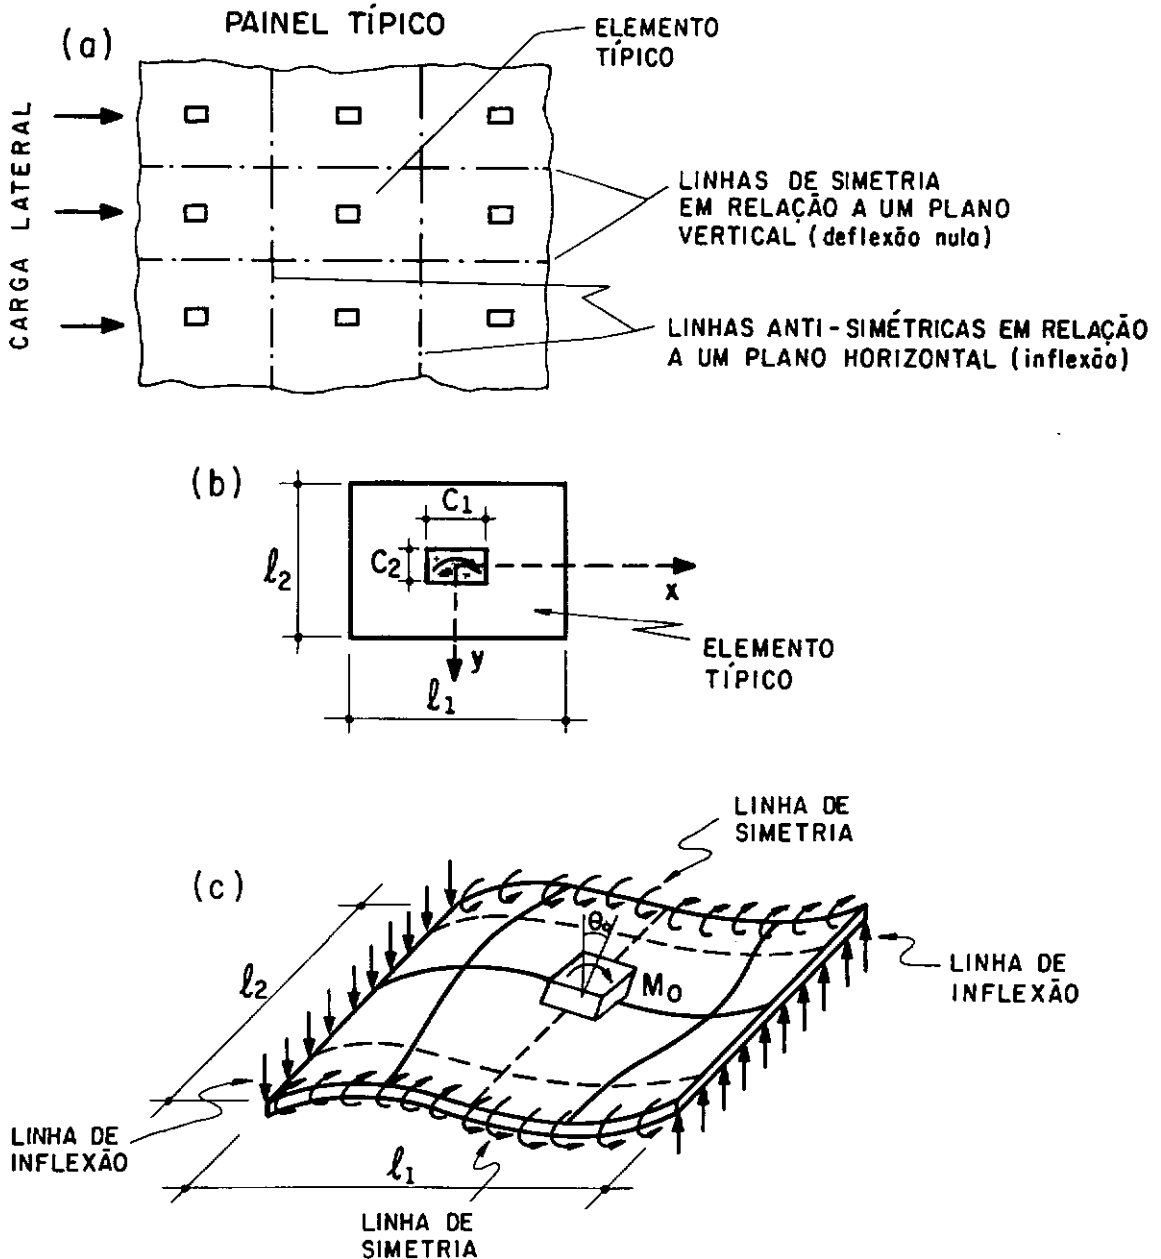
Linhas de simetria e anti-simetria e elemento típico de lajes sem vigaumento.
